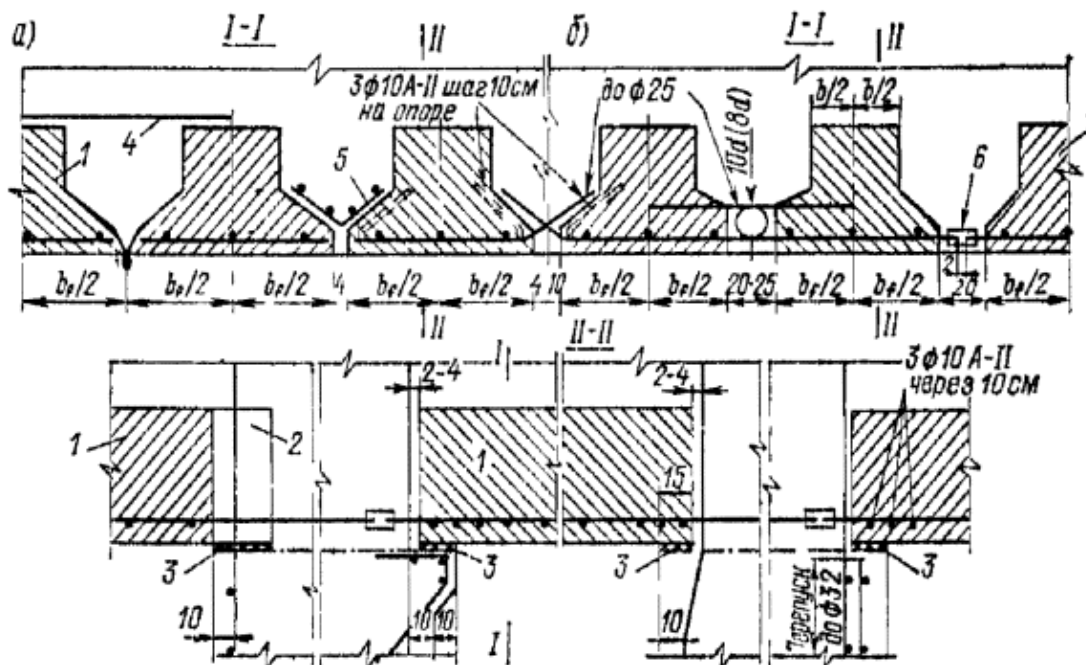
Конструкция сборных несущих железобетонных балок таврового сечения
